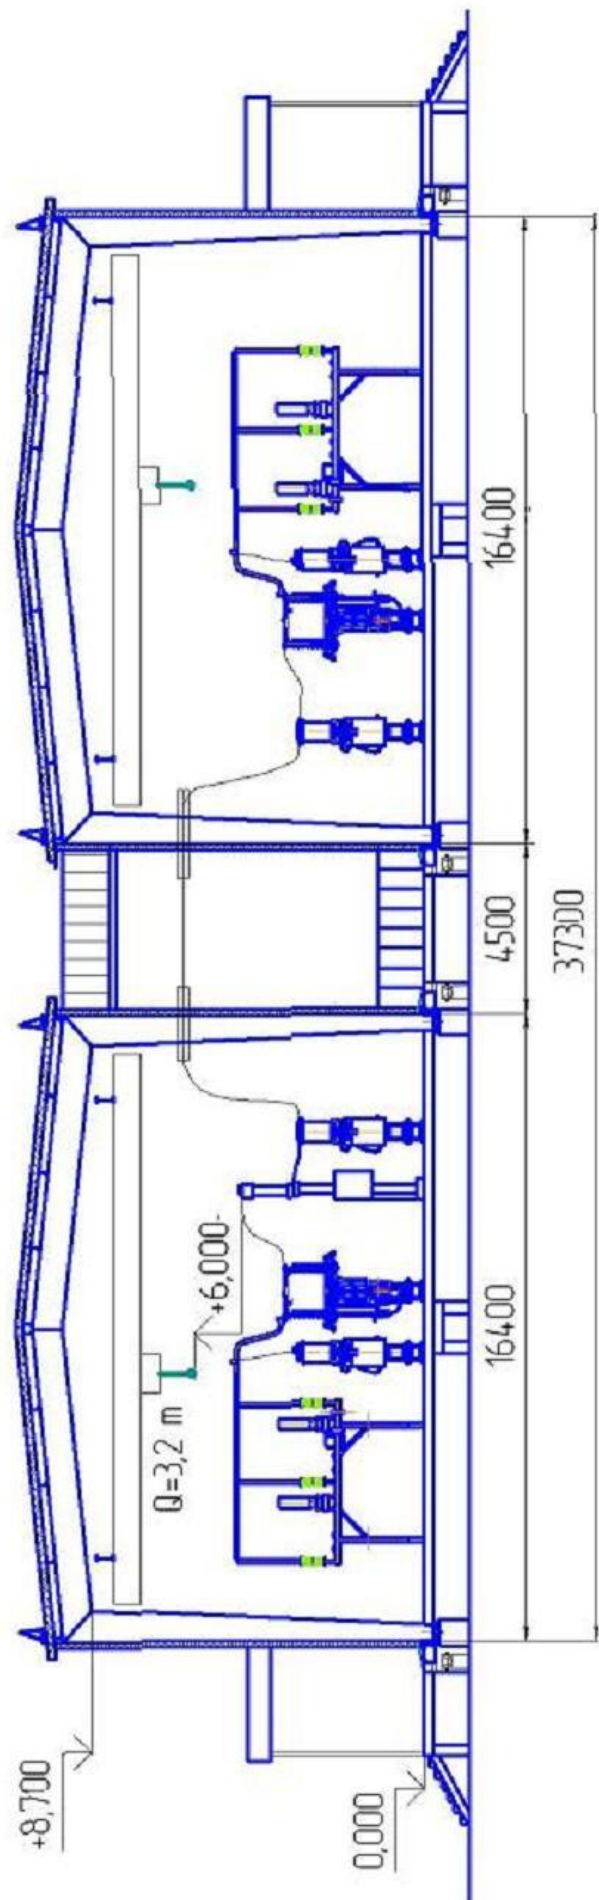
Разрез 1-1 зданий-укрытий схема 110-4Н
